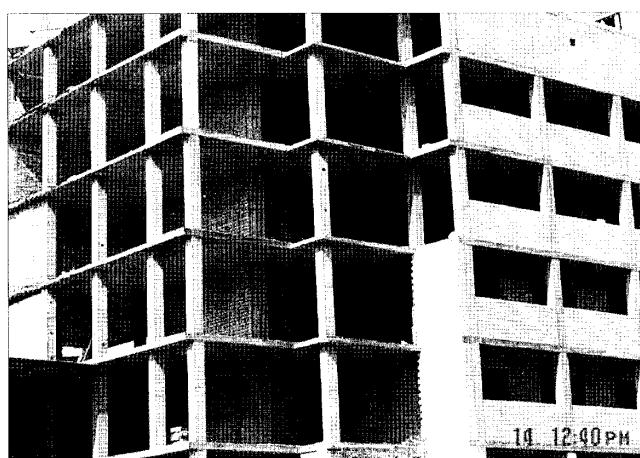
Возведение монолитного несущего каркаса из легких бетонов на пористом шлаковом гравии Новолипецкого металлургического комбината и наружных стен с монолитной теплоизоляцией из полистиролбетона (облицовка кирпичом) при строительстве жилого здания в г. Воронеже
